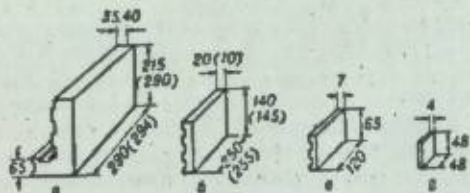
Примеры фасадных облицовочных плит: а — закладная плита рядовая; б — прищипанная, малогабаритная плитка; в — малогабаритная плитка типа «кабанчик»; г — тонкостенная плитка для ковровой керамики.
